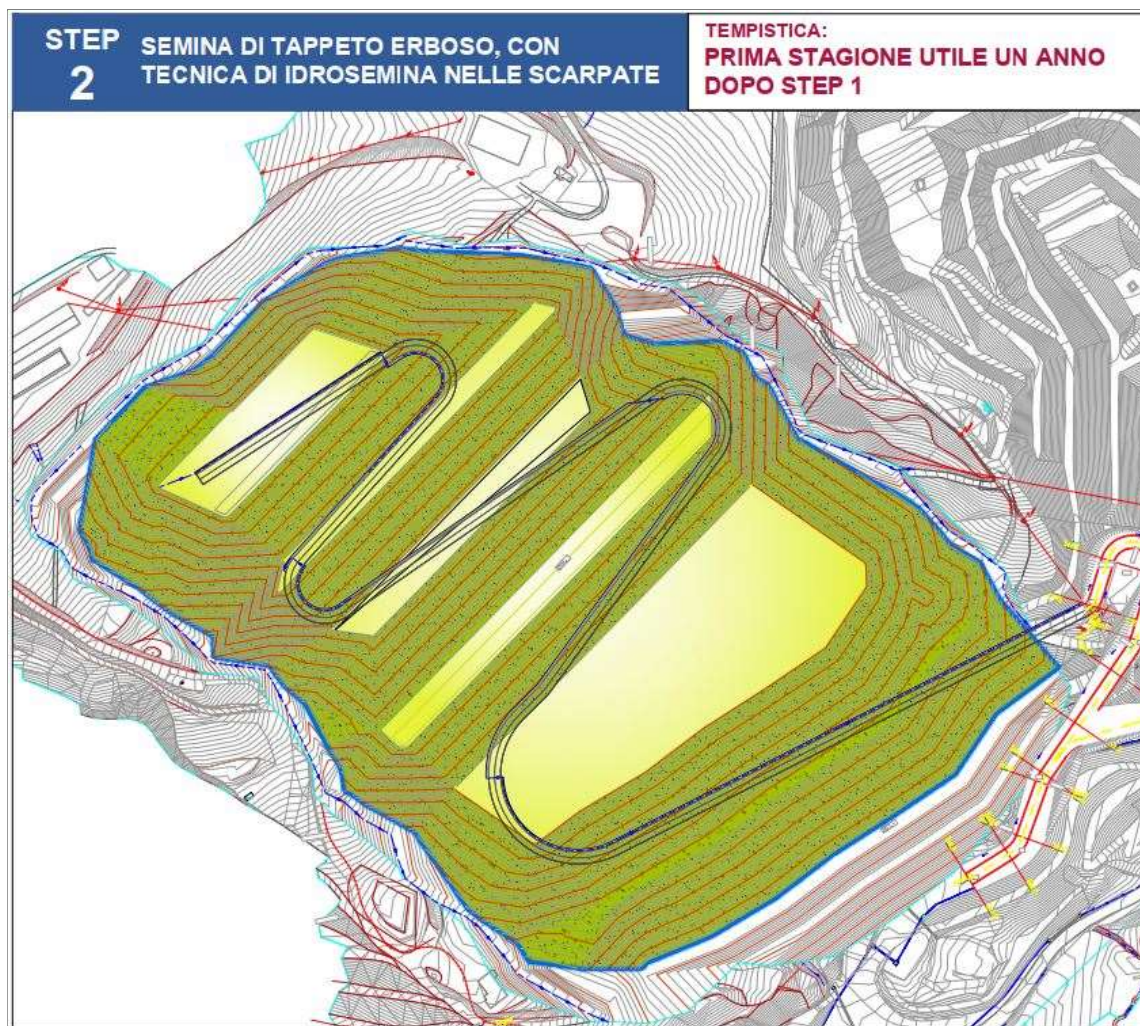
Stralcio della “Planimetria stato di progetto delle opere a verde” (elab. 2.3) con indicazione dell’area di intervento per la semina del tappeto erboso.
